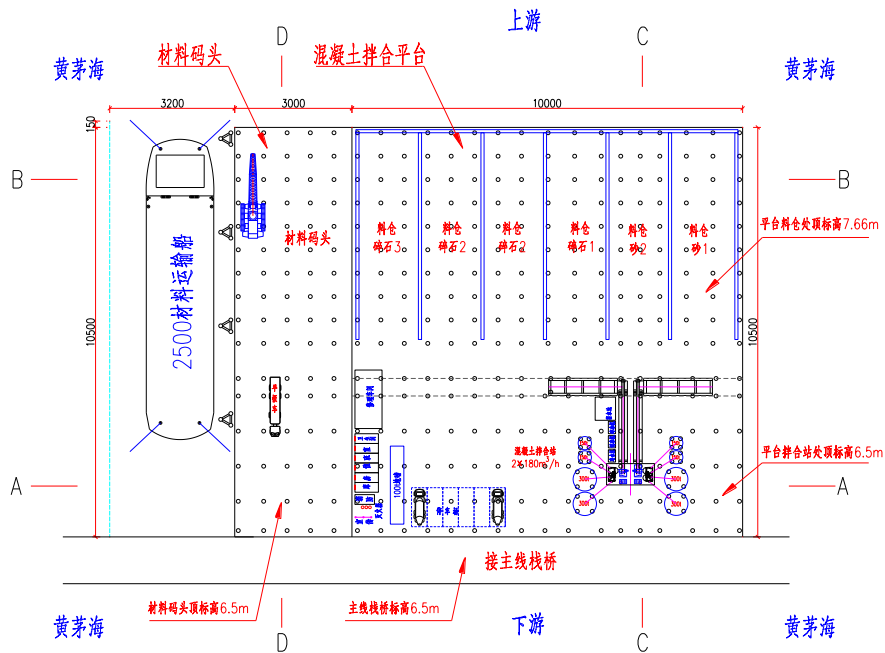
水上拌和平台、材料码头平面布置图（尺寸单位 cm）
